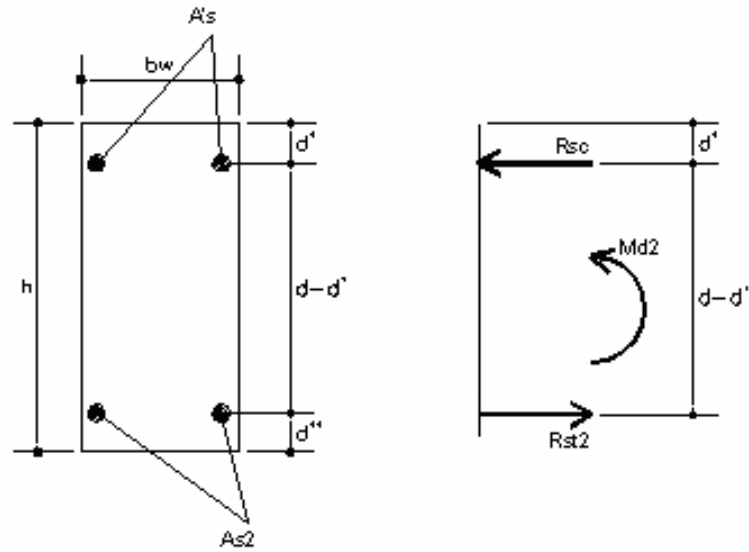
Seção transversal de uma viga retangular sujeita à flexão simples com armadura dupla
